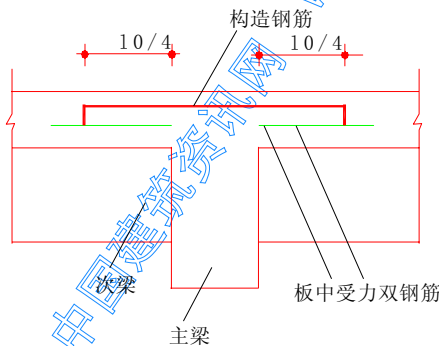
板中与梁肋垂直的构造钢筋配筋
